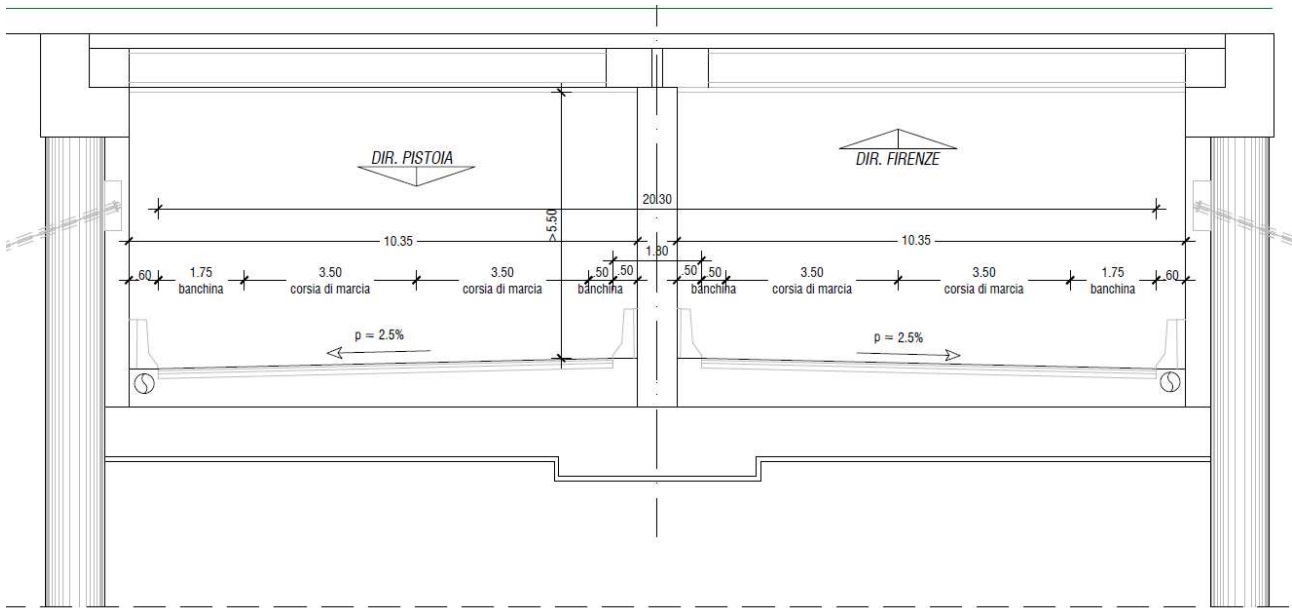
Sezione tipo "ASSE PRINCIPALE"
